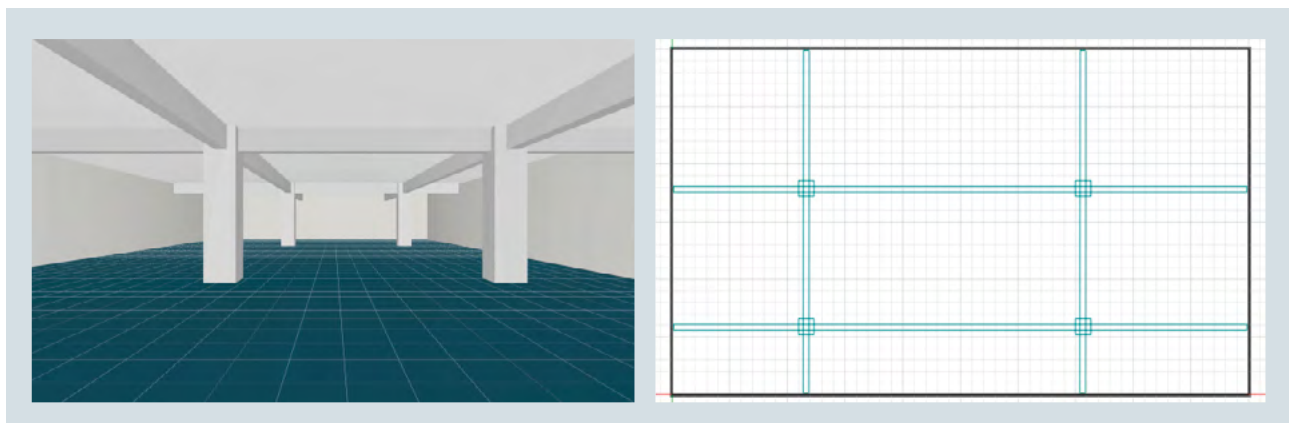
/12: Konzeptfindung für eine Beleuchtungslösung bei der Sanierung einer Industriehalle (links: 3-D-Ansicht; rechts: Grundriss)
